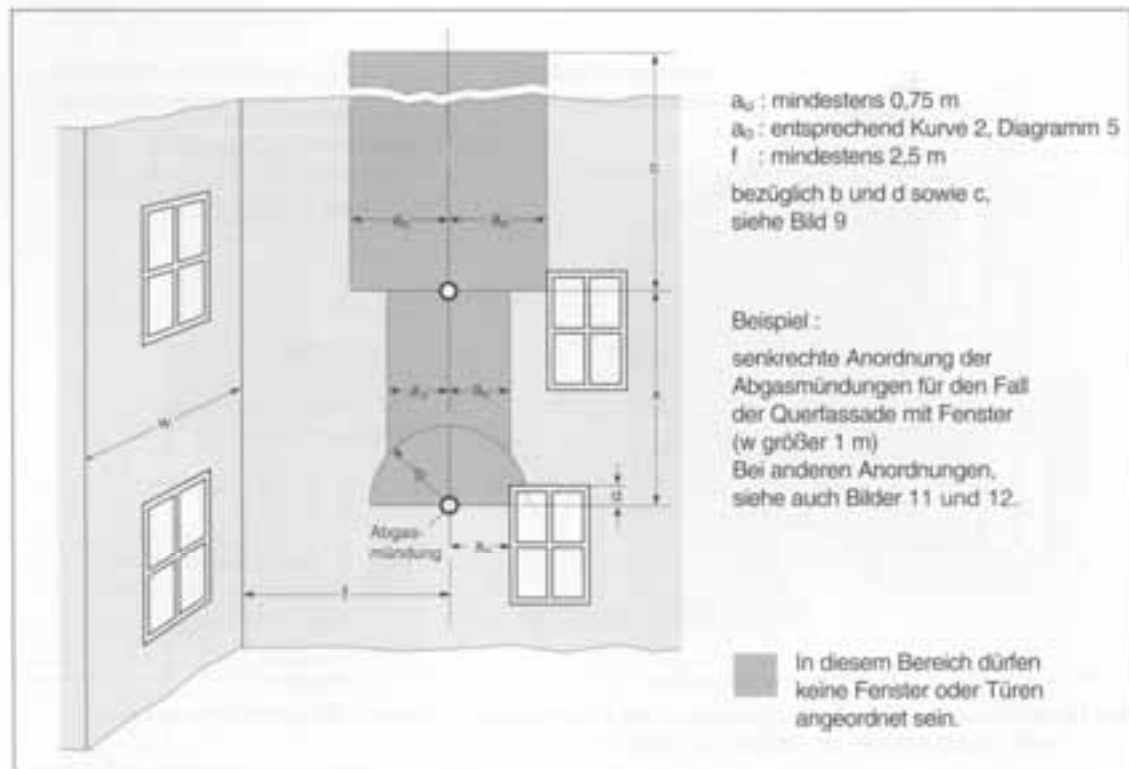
Mindestabstände von Abgasmündungen einer Zweier-Gruppe zu Fenstern, die geöffnet werden können, oder Fassadentüren – bei Fassaden in Ecklage (Querfassade mit Fenstern)
